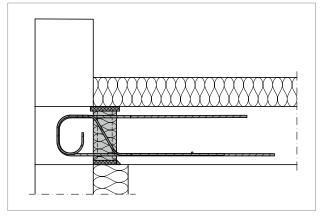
Schöck Rutherma® T type DFi : liaison dans la zone de l'acrotère
